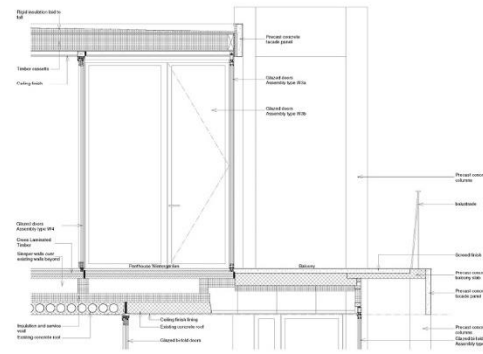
Sección constructiva - Nuevas viviendas azotea
